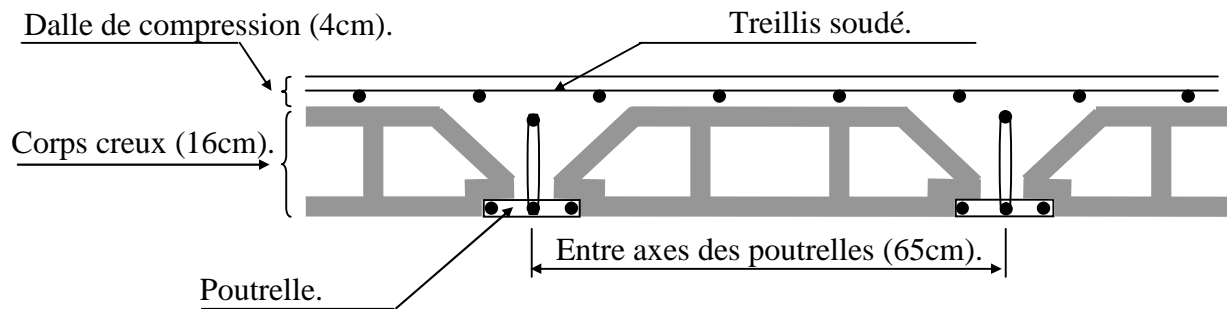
Coupe verticale d'un plancher en corps creux.
